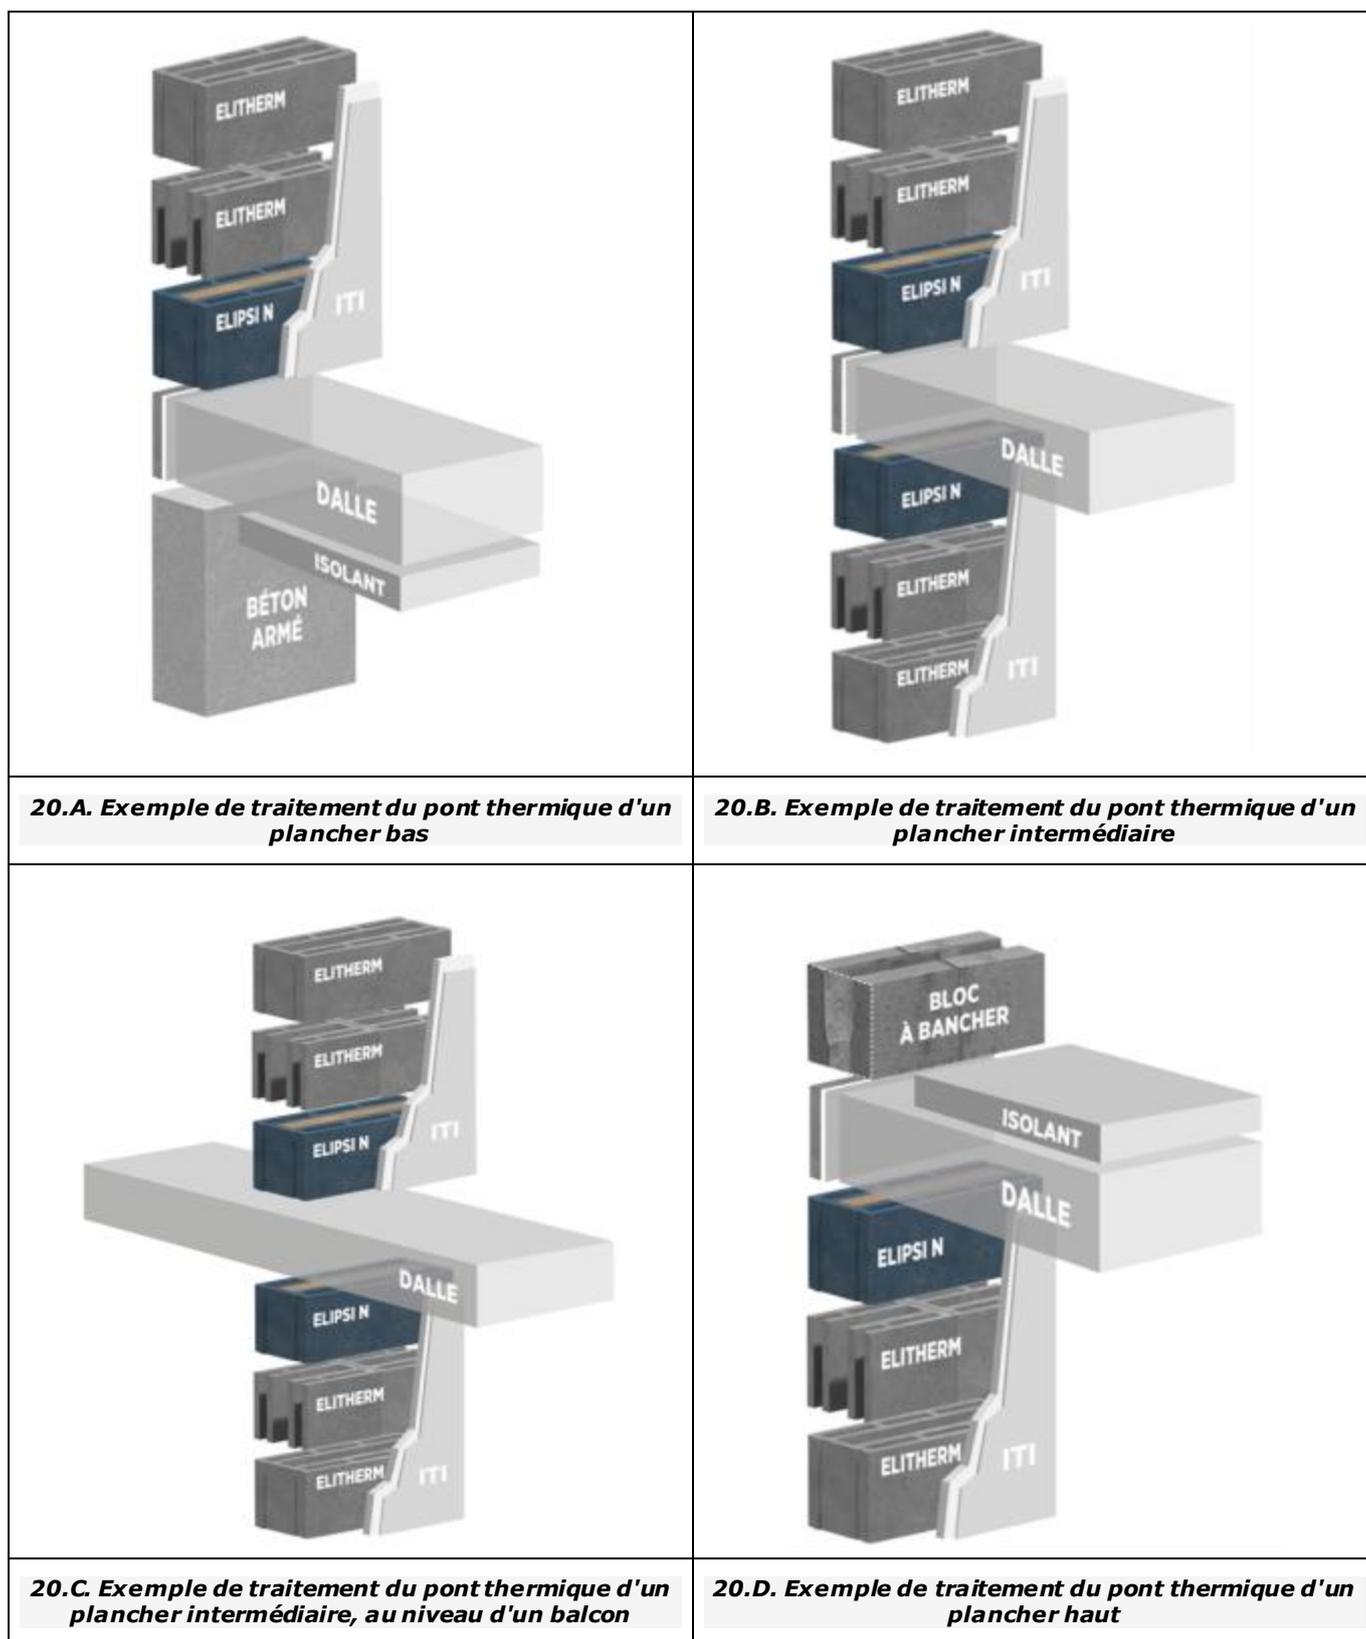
Exemples jonctions entre planchers et murs de façade de la solution R+Mur N (uniquement : Blocs ELIPSI N associés avec les blocs ELITHERM)
